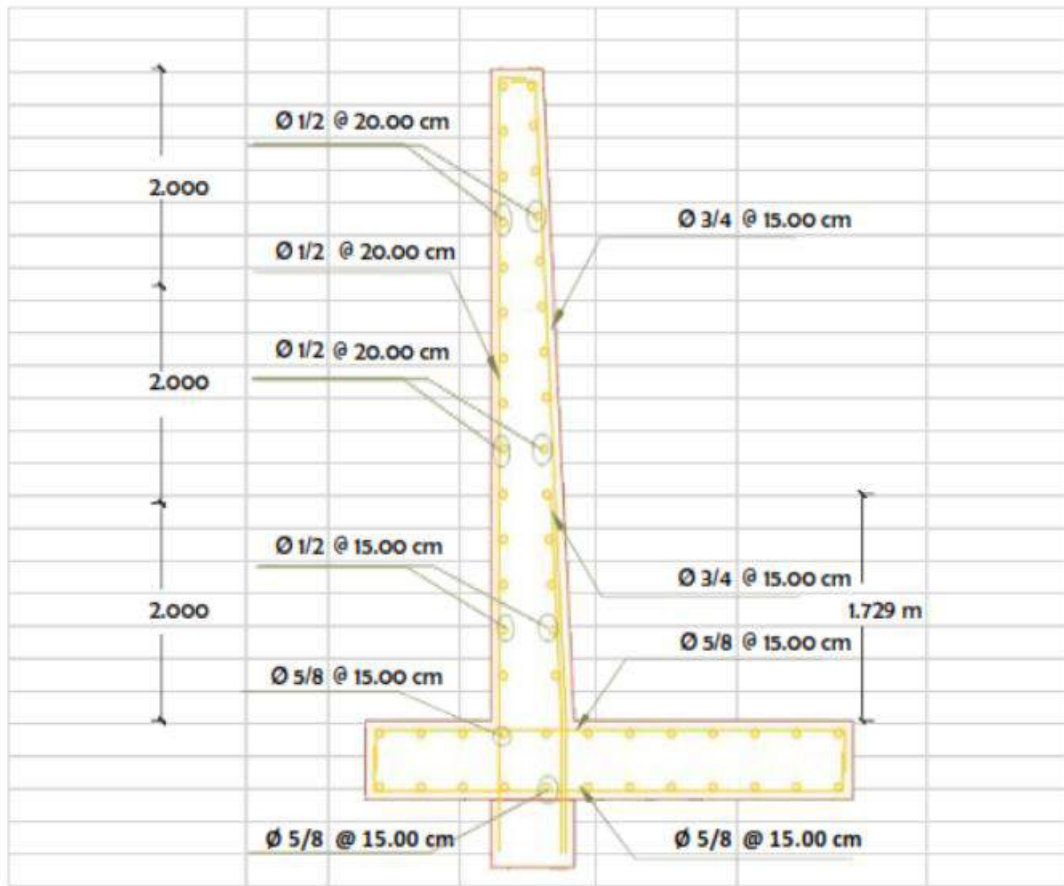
Detalle de acero – Muro de contención de concreto armado (en voladizo)  $H = 6.00\text{ m}$
